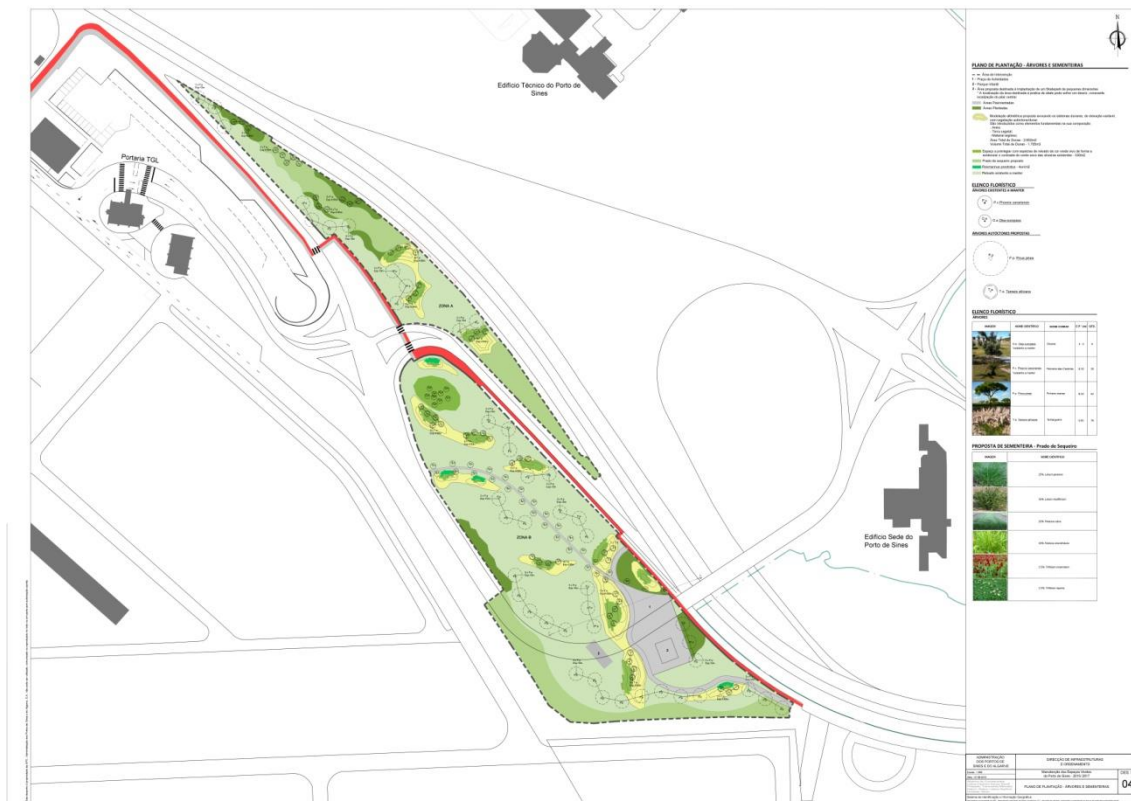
Plano de plantação de árvores e sementeiras.
